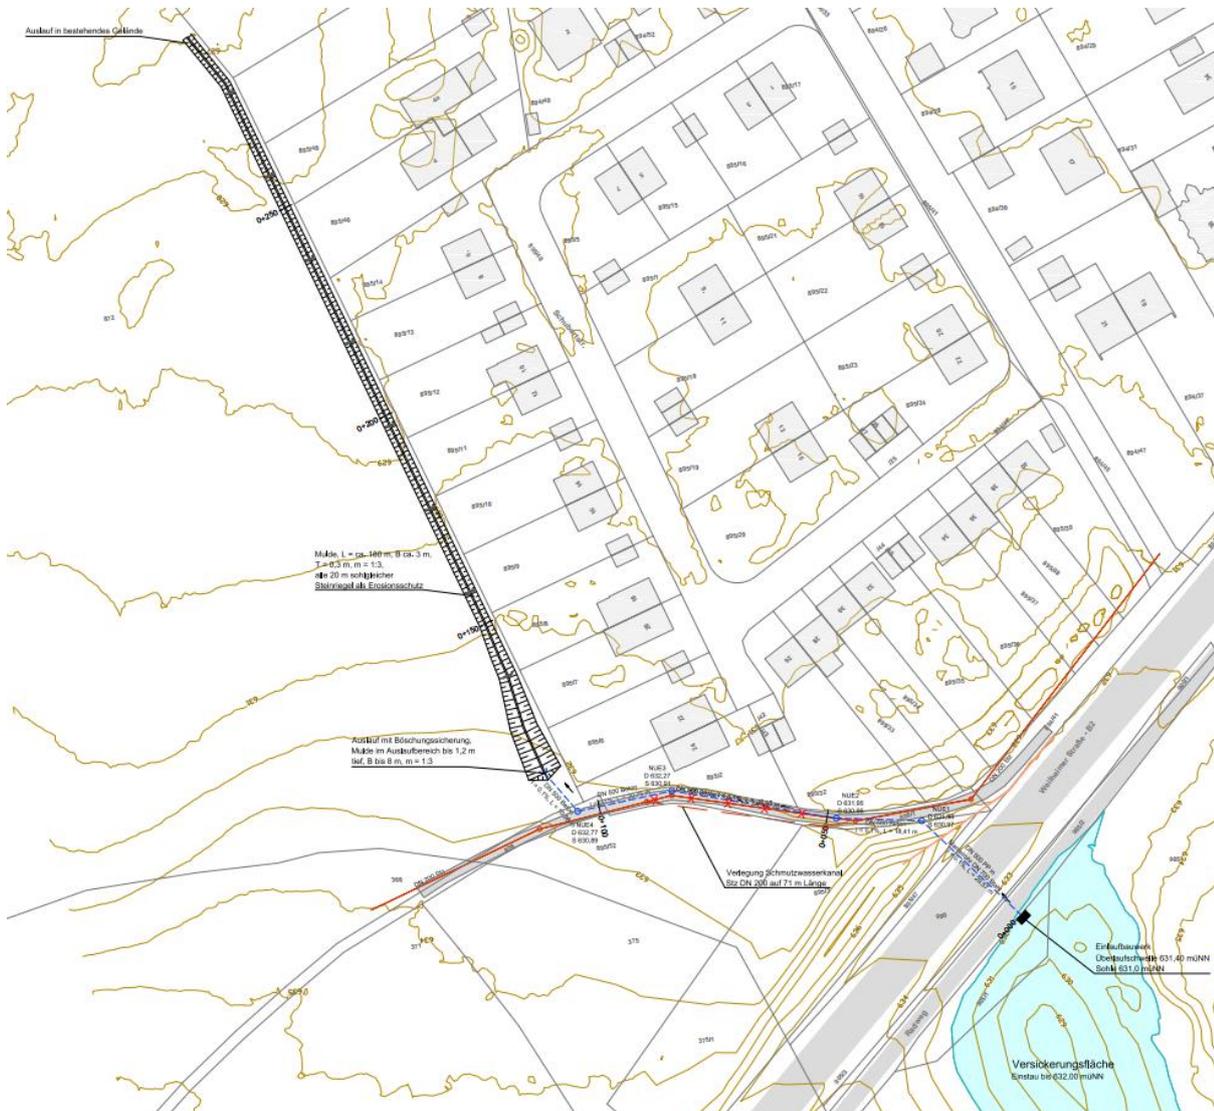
Plan E40 - Lageplan 1 : 500 (siehe Anl. 3)
